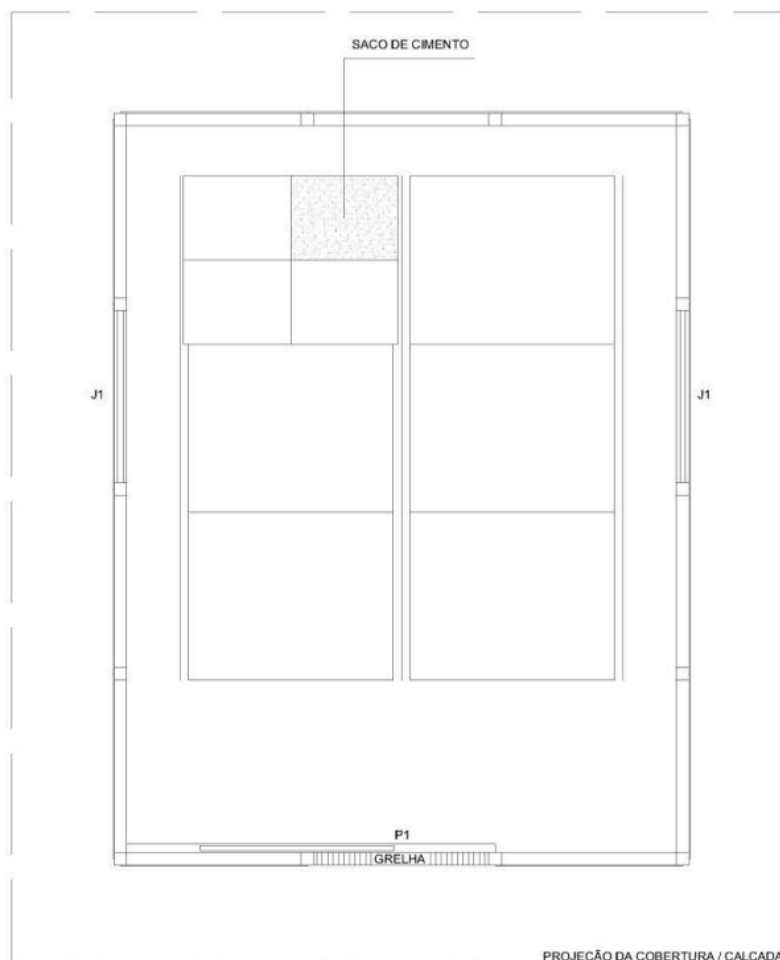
Layout do depósito em madeira – código 93584 (SINAPI). Fonte: Caderno Técnico de Composições para "Instalações para Canteiros de Obras" – SINAPI (aferição 12/2016, atualização 05/2021).
